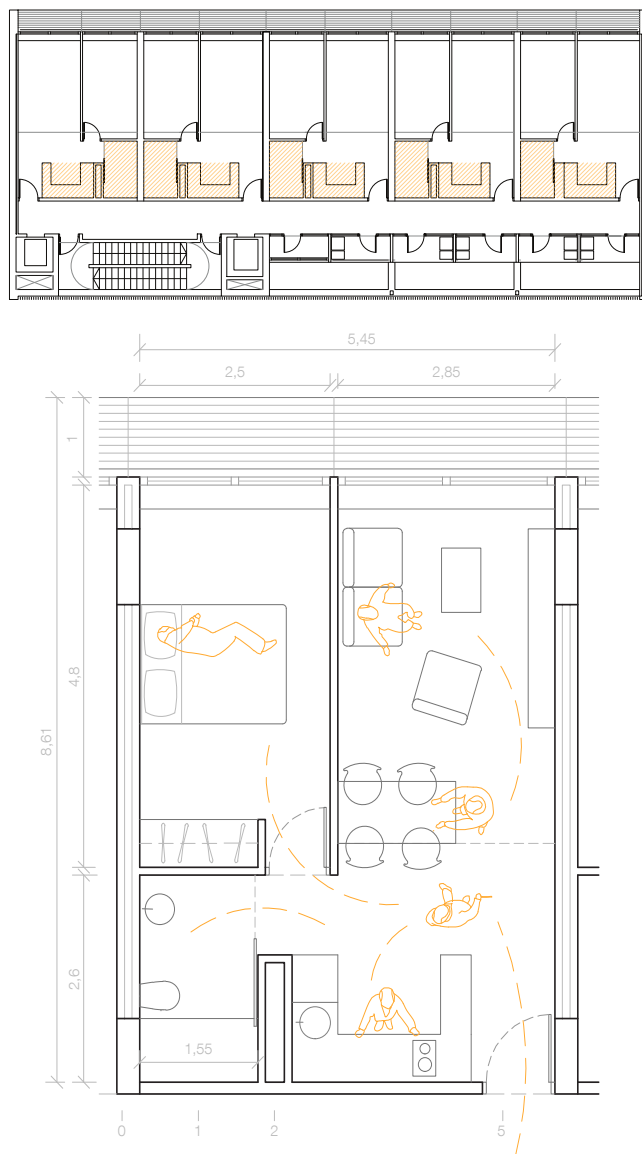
Planta general del edificio de viviendas para mayores en Benidorm. (2005-2008) Javier García-Solera
